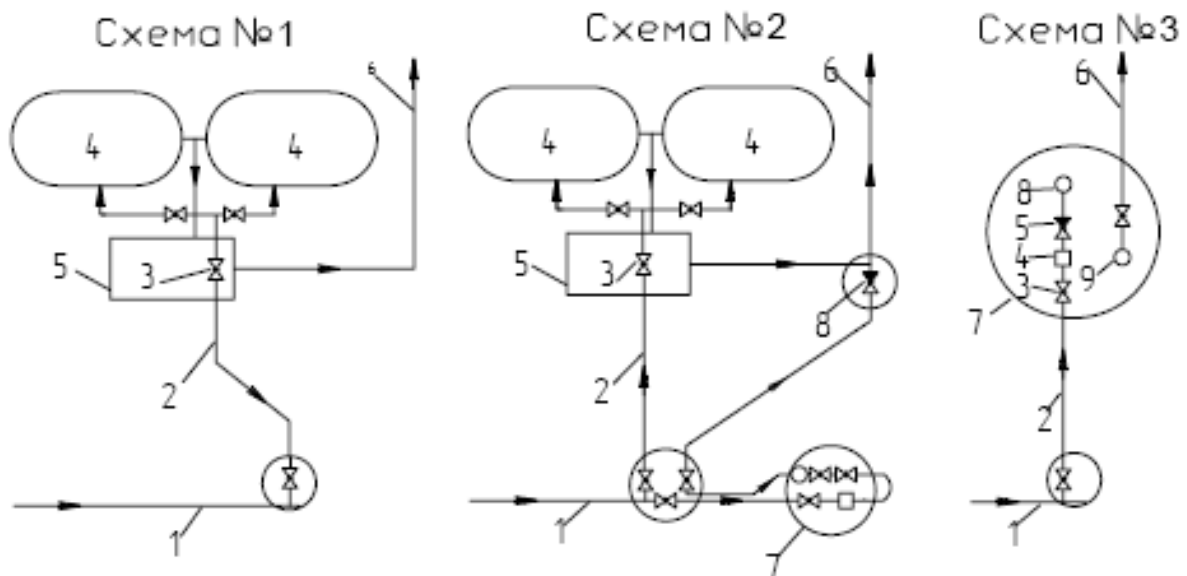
Схемы подключения систем водоснабжения к водоводам групповых водопроводов
